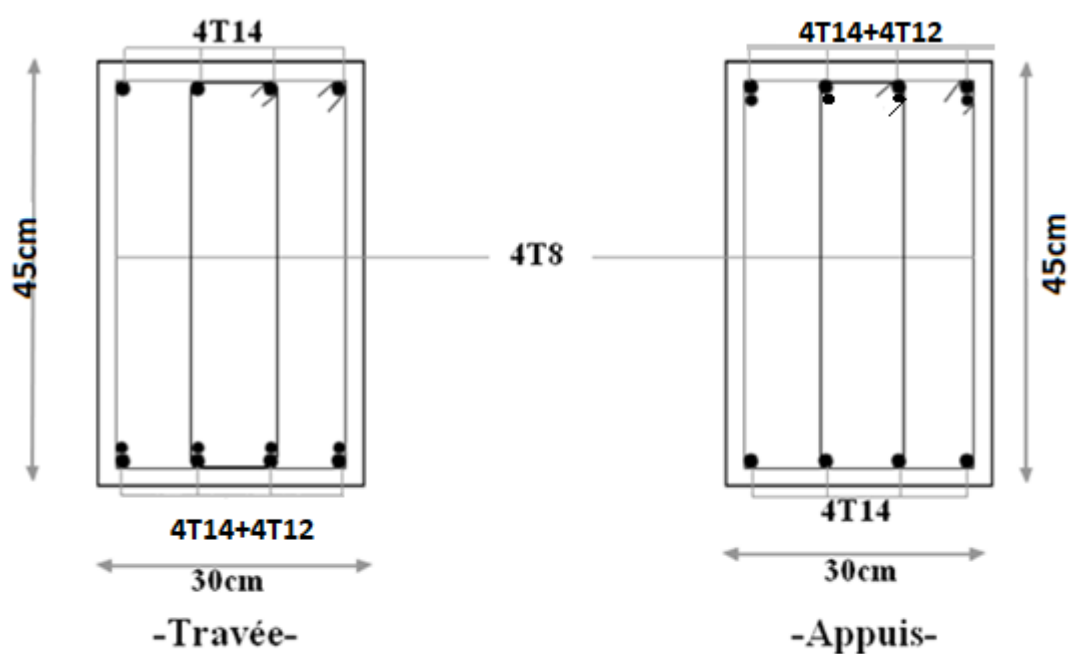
Schéma de ferrailage des poutres principales de la terrasse.
